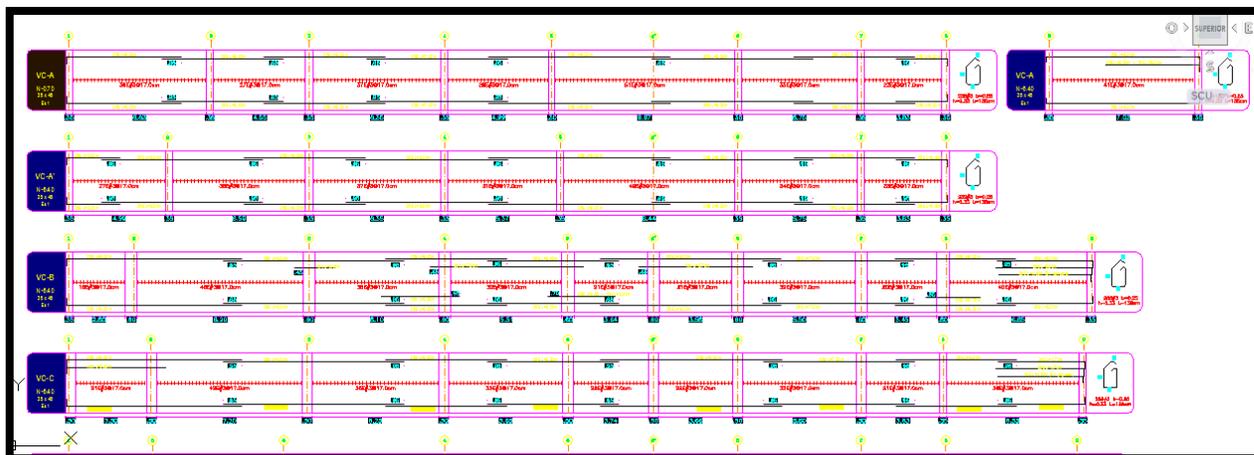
Plano estructural correspondiente al despiece de las vigas de cimentación.
